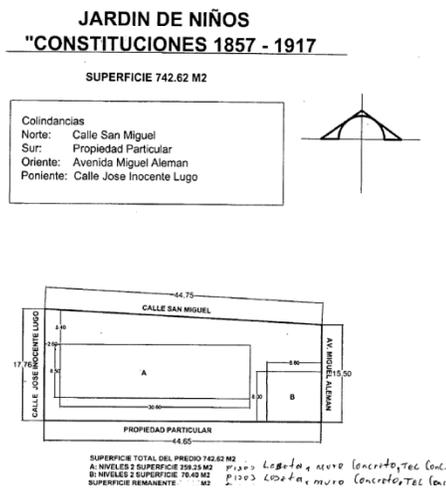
Aplicación de Encuestas en Planteles Escolares
